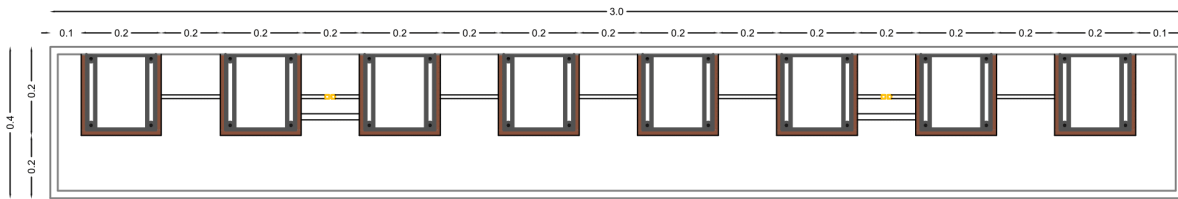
Plan (partie médiane du dispositif) montrant la fixation des filtres sur la plaque du monobloc Source : Auteurs
